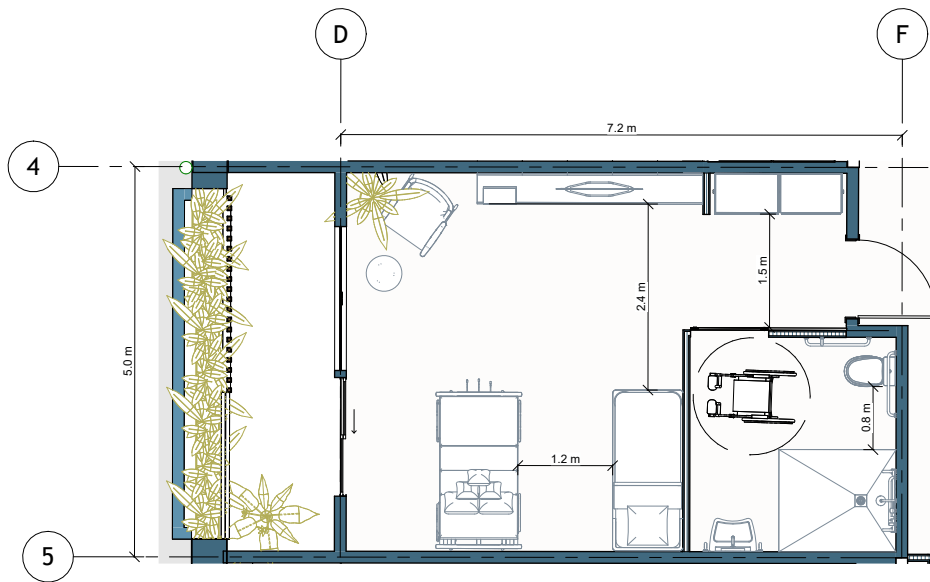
Planta arquitectónica del dormitorio. Fuente: Elaboración propia.
